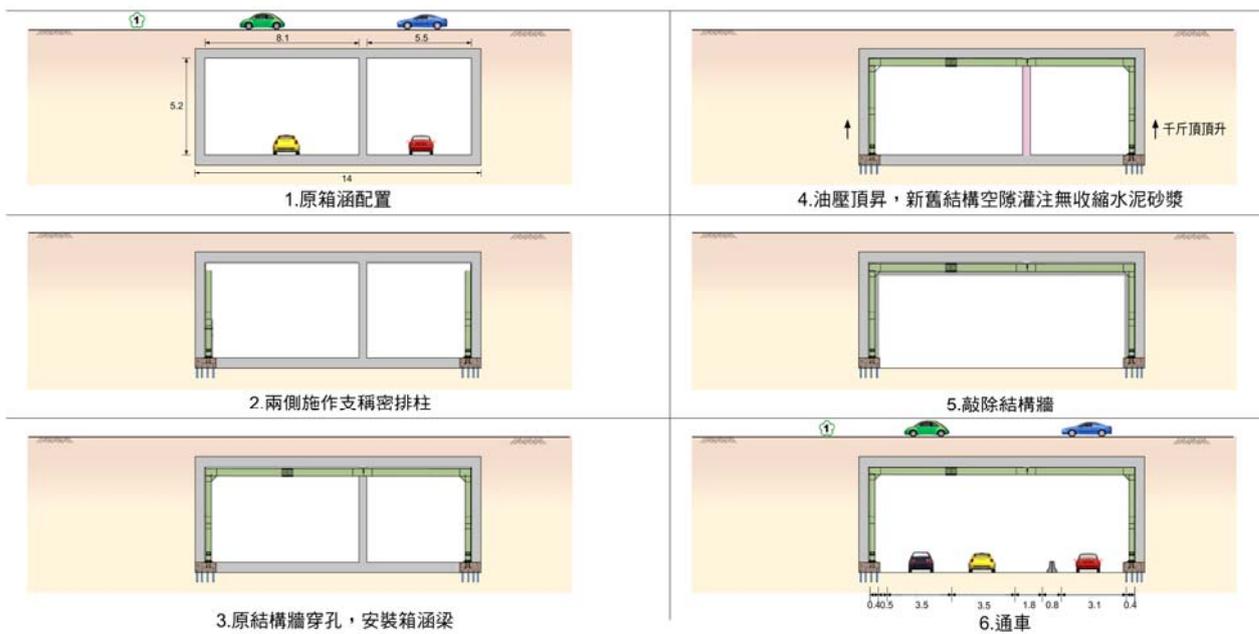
箱涵鋼梁頂昇施工示意圖
